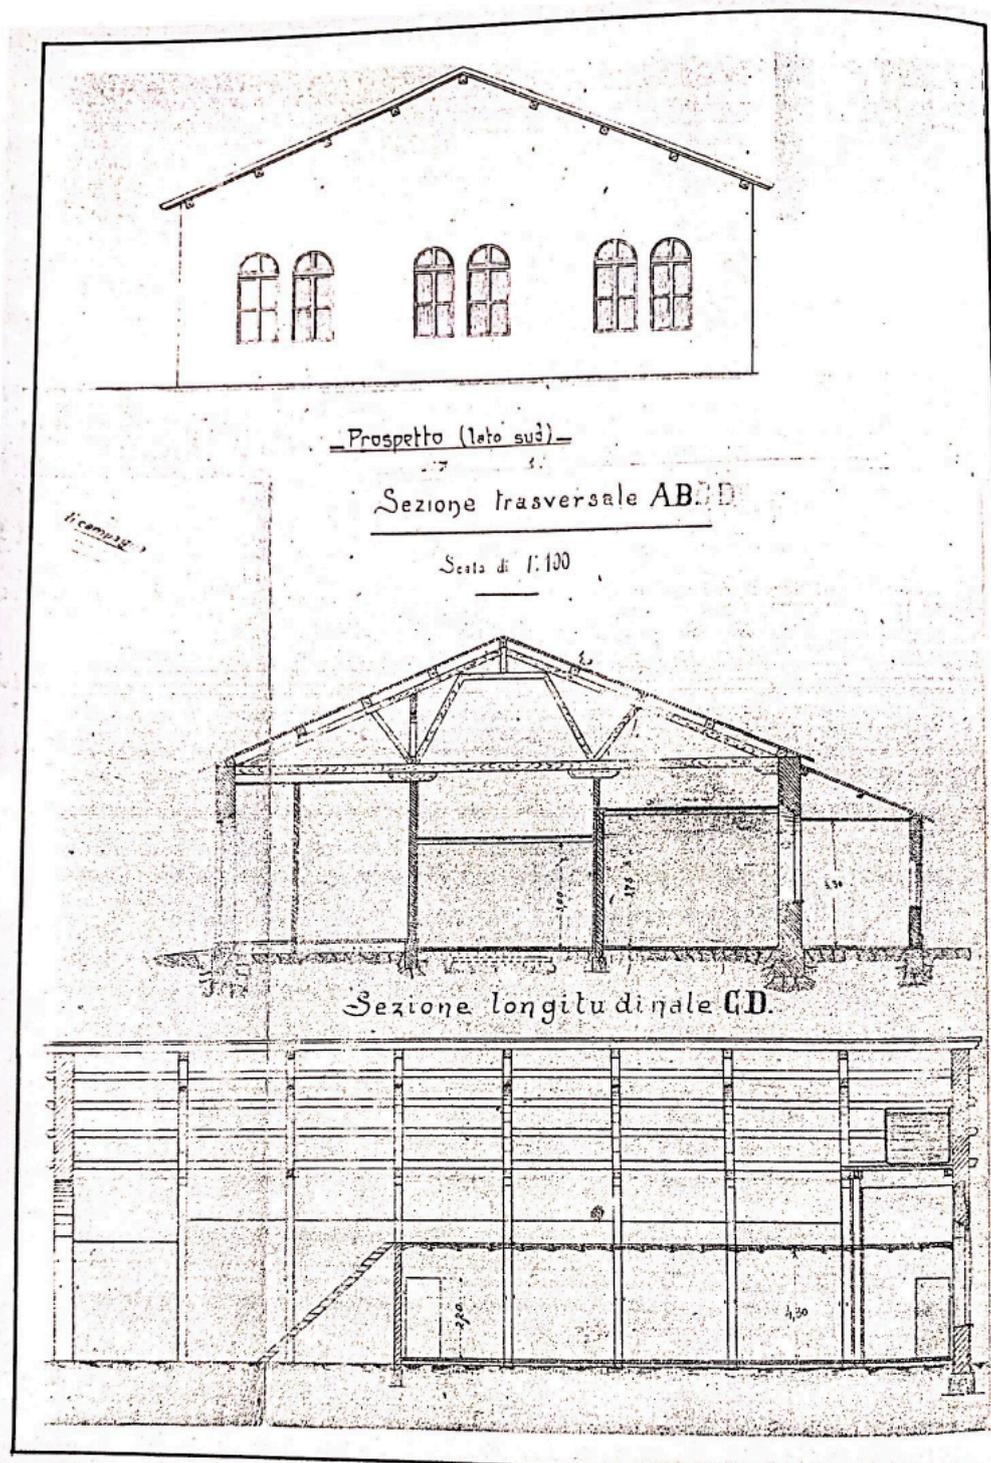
Progetto della prima stazione di Savona, in particolare prospetto e sezioni trasversale e longitudinale. Da Franco Rebagliati, Mario Siri, *Savona Letimbro: Album della stazione (1868-1924)*, Pinerolo, Alzani Editore, 1992 pg. 50.
